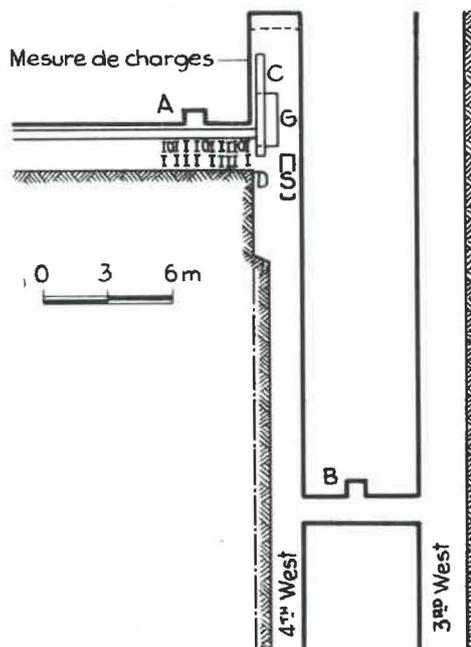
Plan à plus grande échelle donnant la situation des niches d'essais
